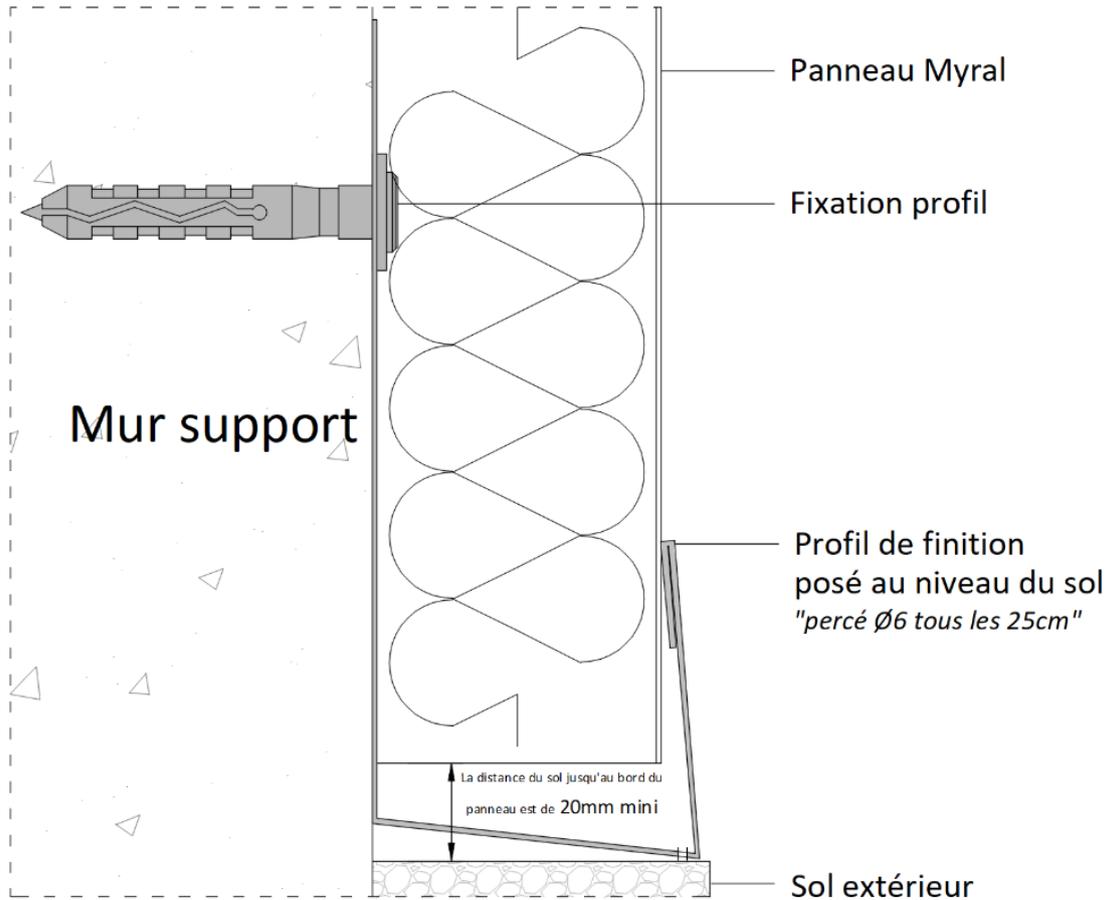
Bas de façade – Pose en vêtage (coupe verticale)
